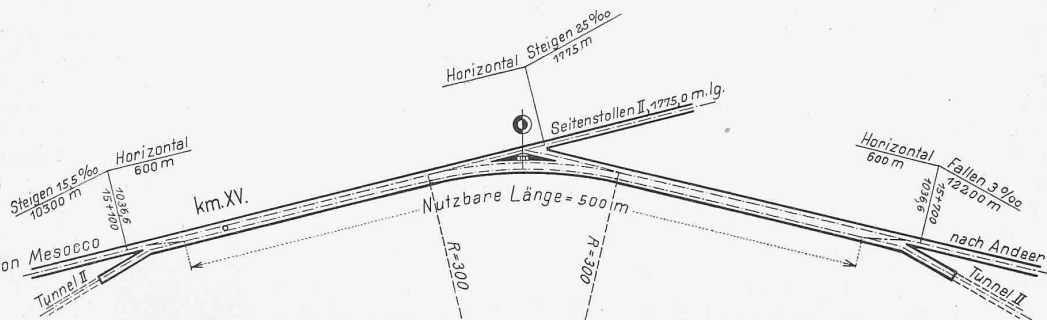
Lageplan der Tunnelstation bei Seitenstollen II. — Masstab der Längen 1 : 5000.
